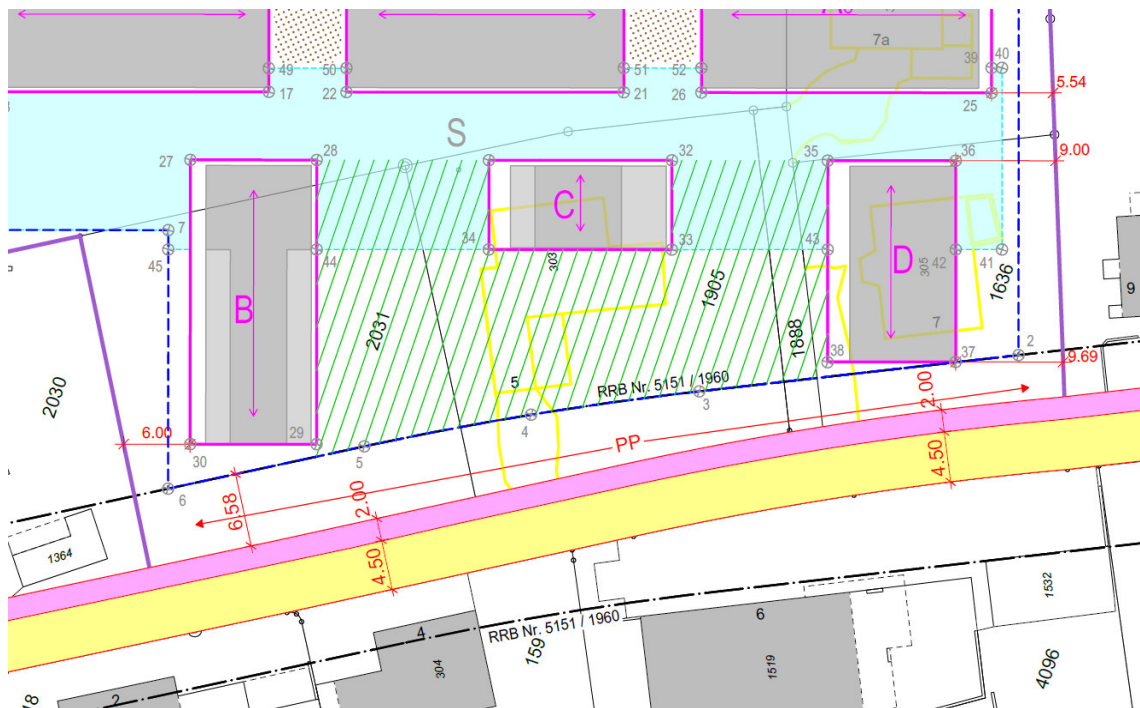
Ausschnitt Gestaltungsplan mit möglichem Ausbau der Haldenstrasse
